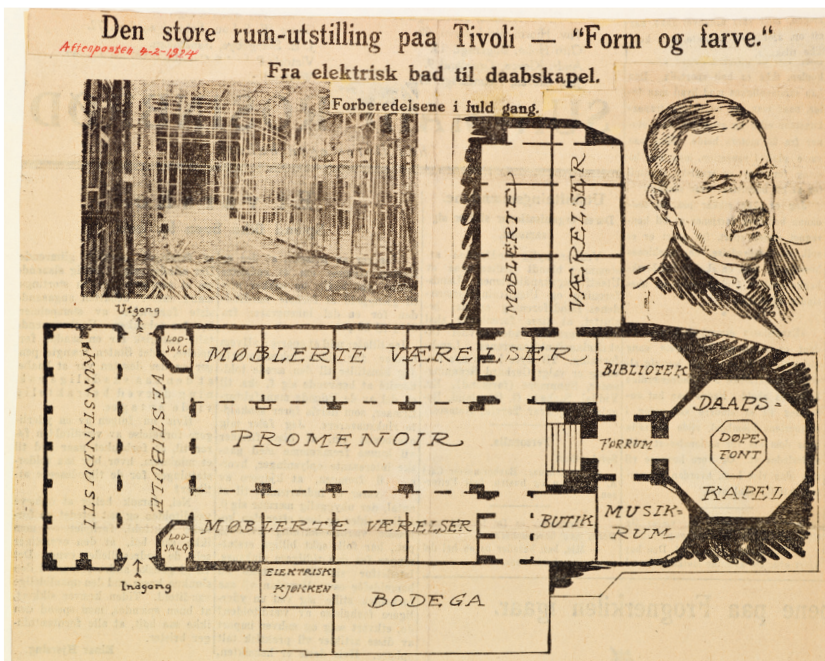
Foto og plan fra planleggingen av utstillingen i hovedpaviljongen. *Aftenposten*, 4. februar, 1924.
